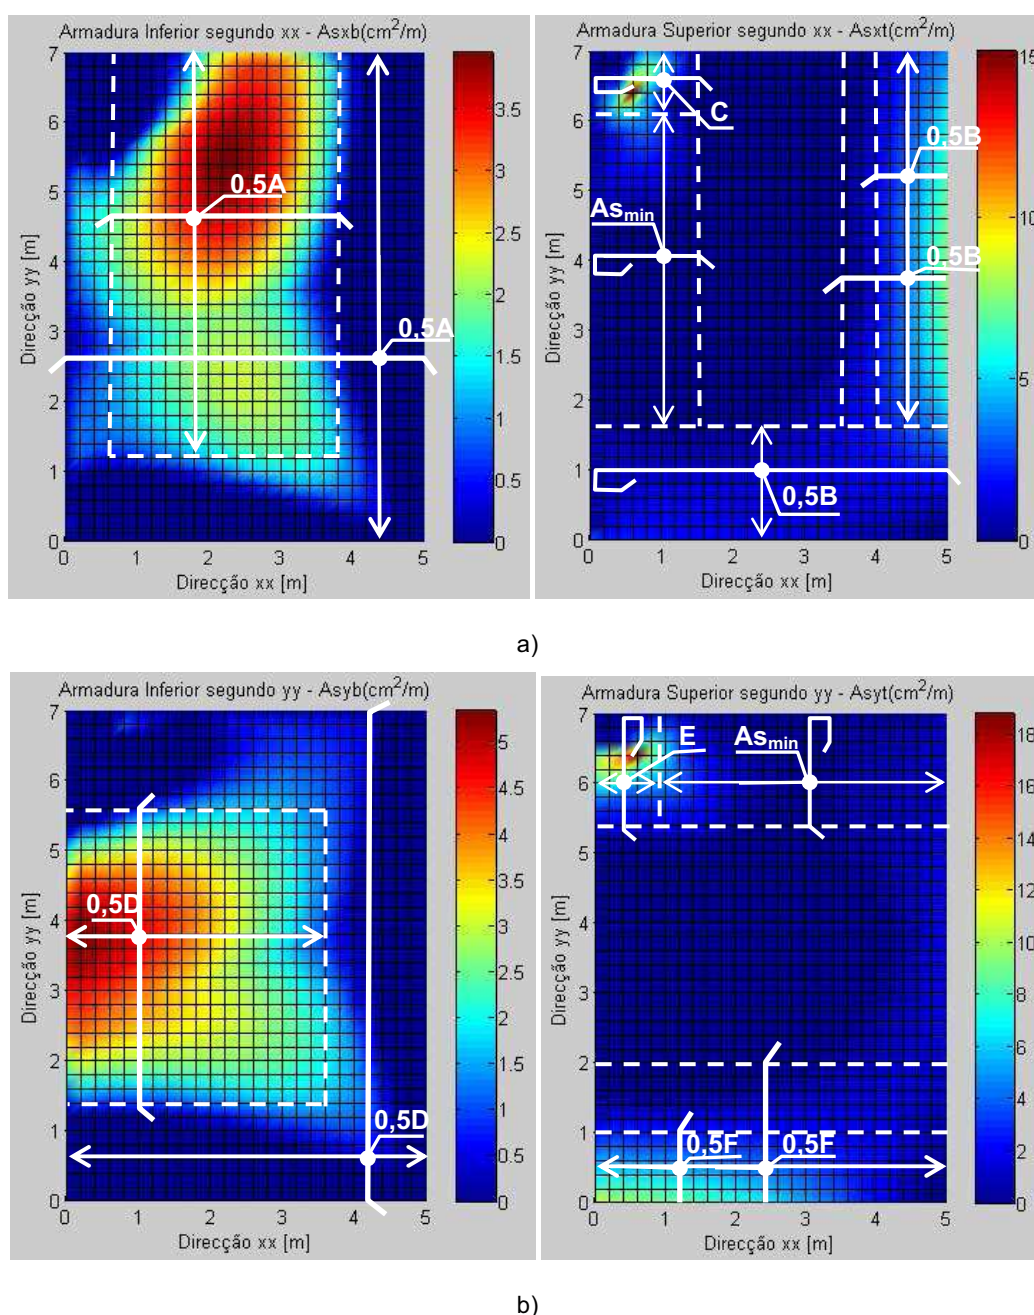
a) Armaduras segundo a direcção x; b) Armaduras segundo a direcção y
